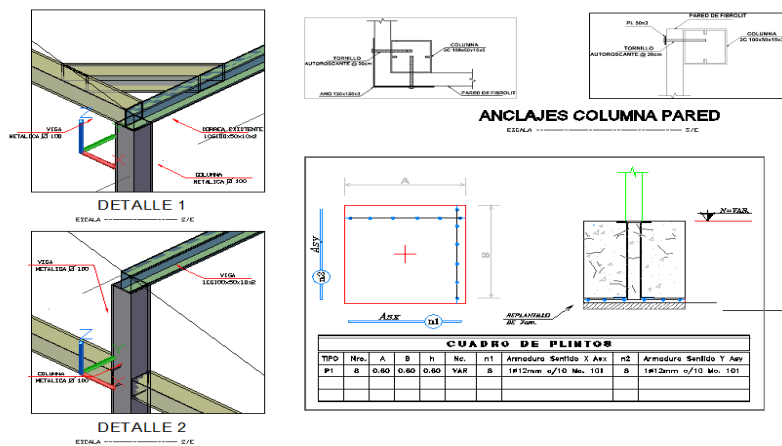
18 Planos constructivos de conexiones para reforzamiento propuesto.
